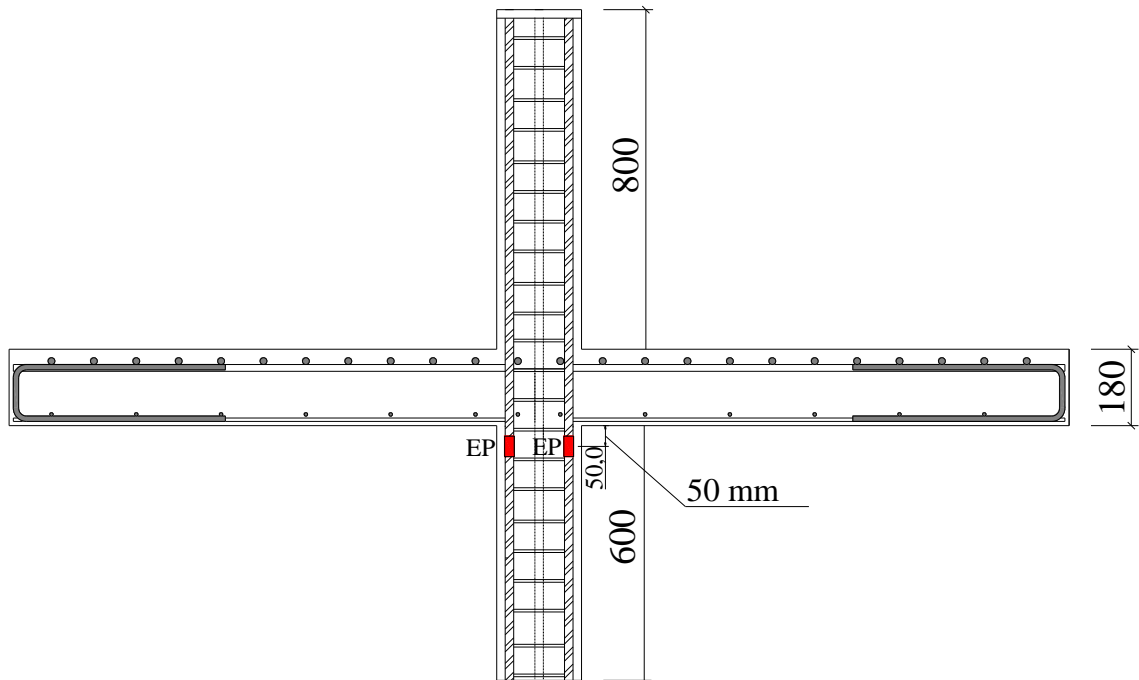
Seção transversal com armadura dos pilares (LS01, LS02 e LS03) e posição dos EER.
